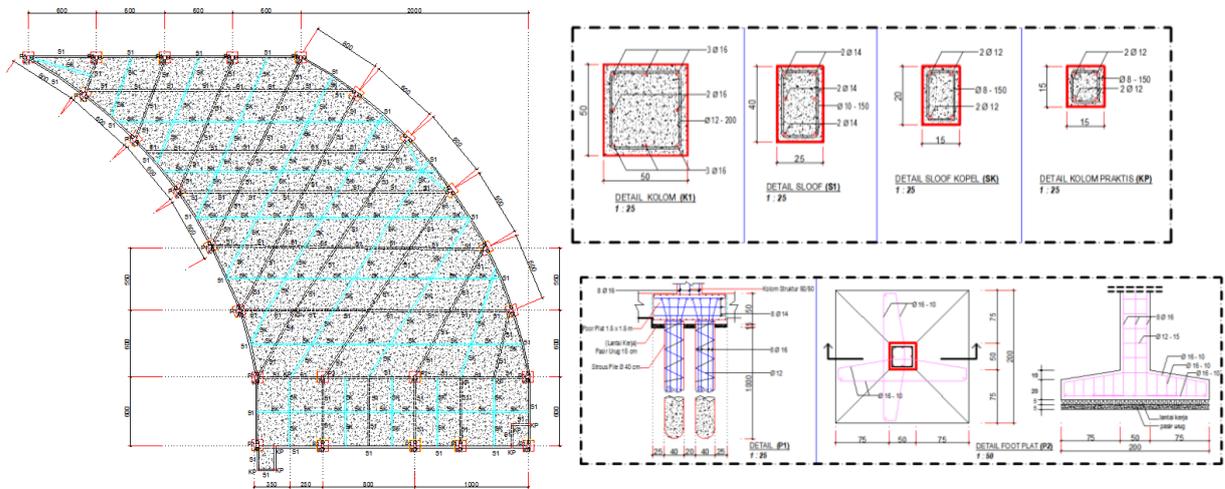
Rencana Pembalokan Gedung Workshop “A”
